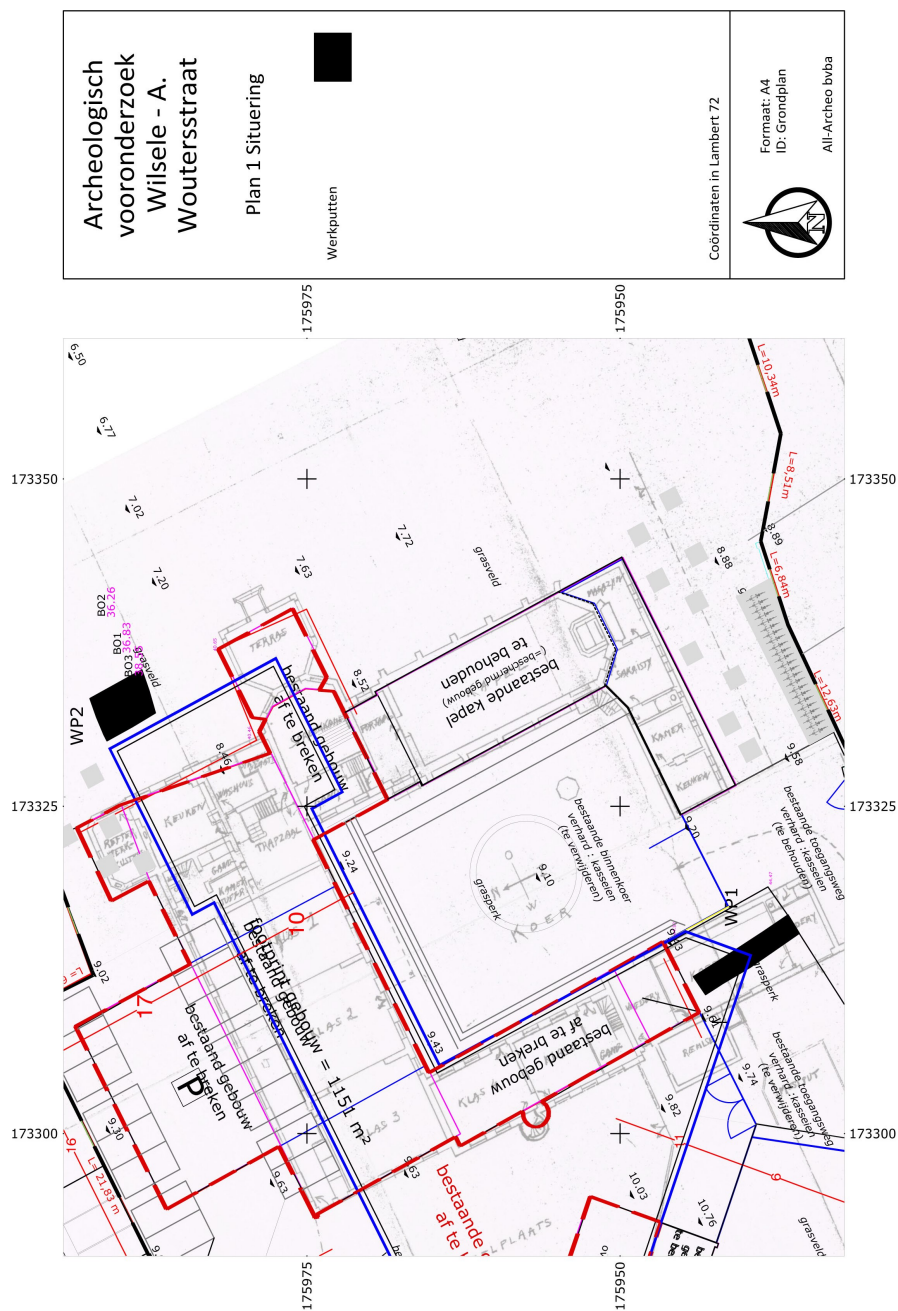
Situeringplan met rood omlijnd de te slopen bebouwing, blauw de geplande nieuwbouw en het grondplan uit 1944 als onderkaart
